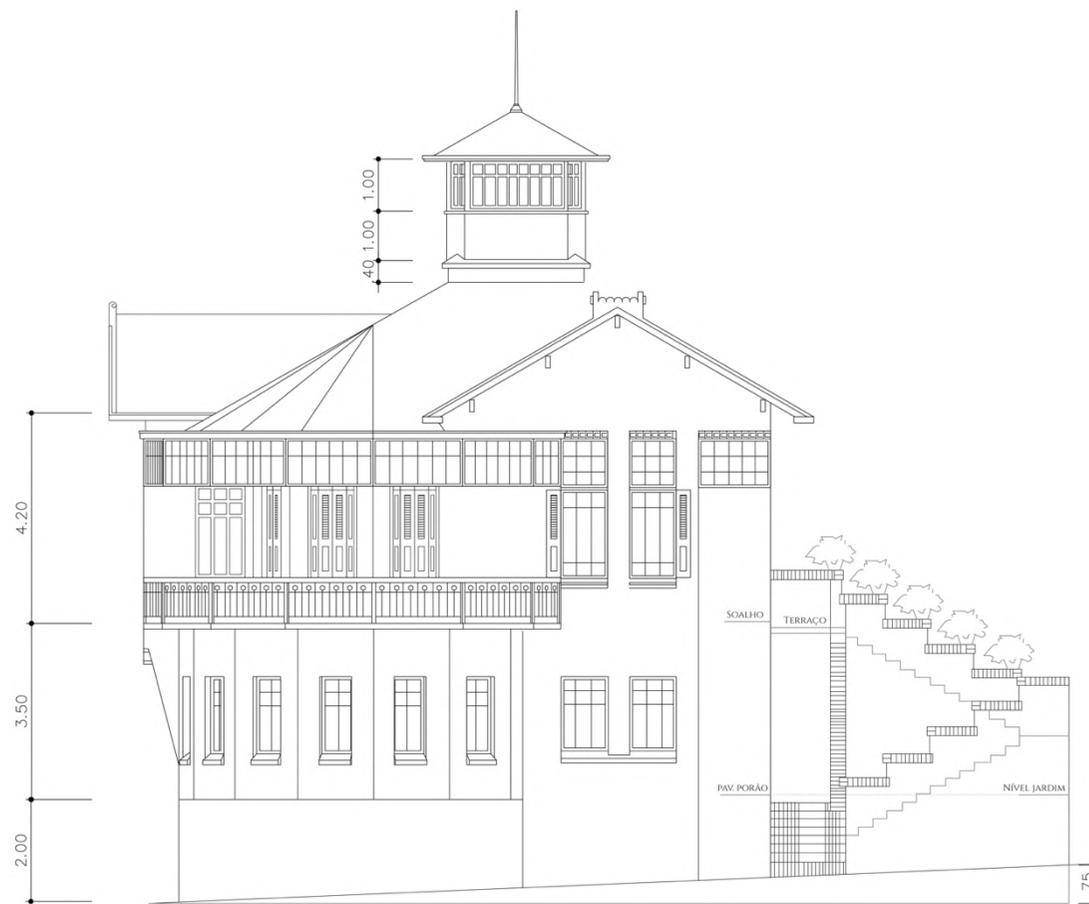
Estudo de elevação da Villa Vicente Soares de Barros (1910), com destaque para as relações de alturas dos pavimentos e para a relação entre a escadaria do pavimento térreo e a escada de acesso ao andar do porão.
